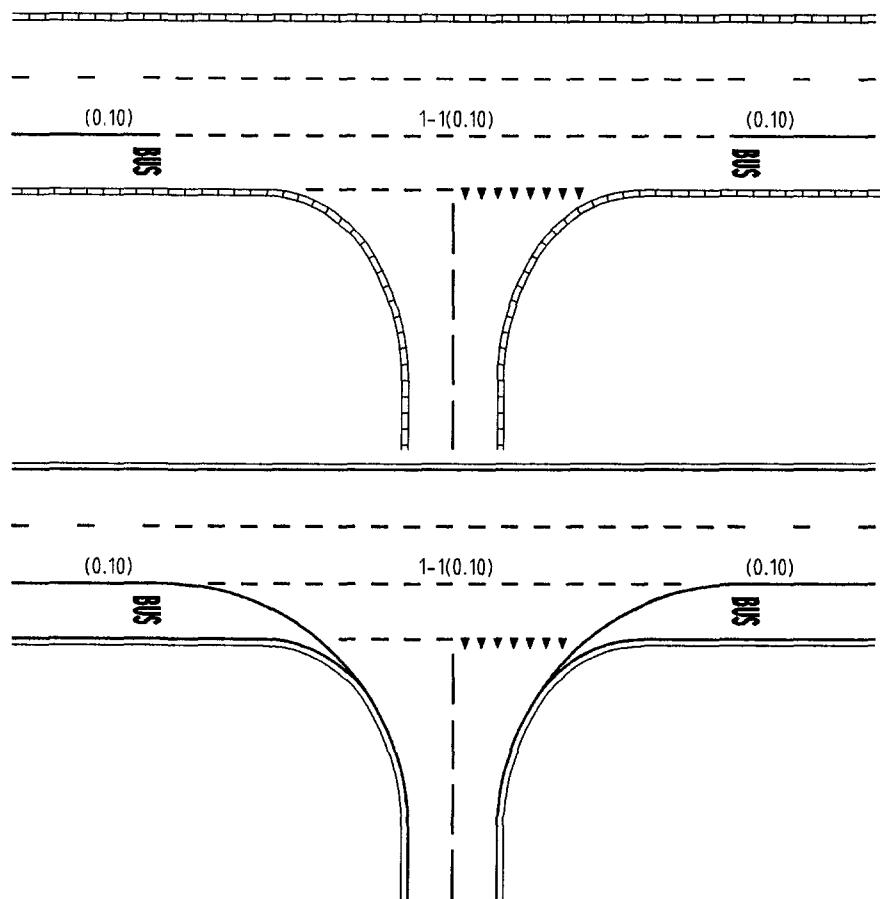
Markering openbaar-vervoerbaan met aanliggende parkeerstrook
